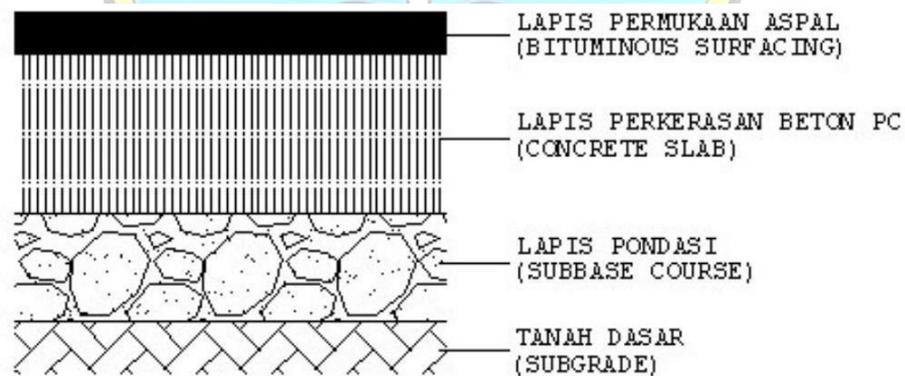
Susunan Lapis Perkerasan kaku (*Rigid Pavement*)
